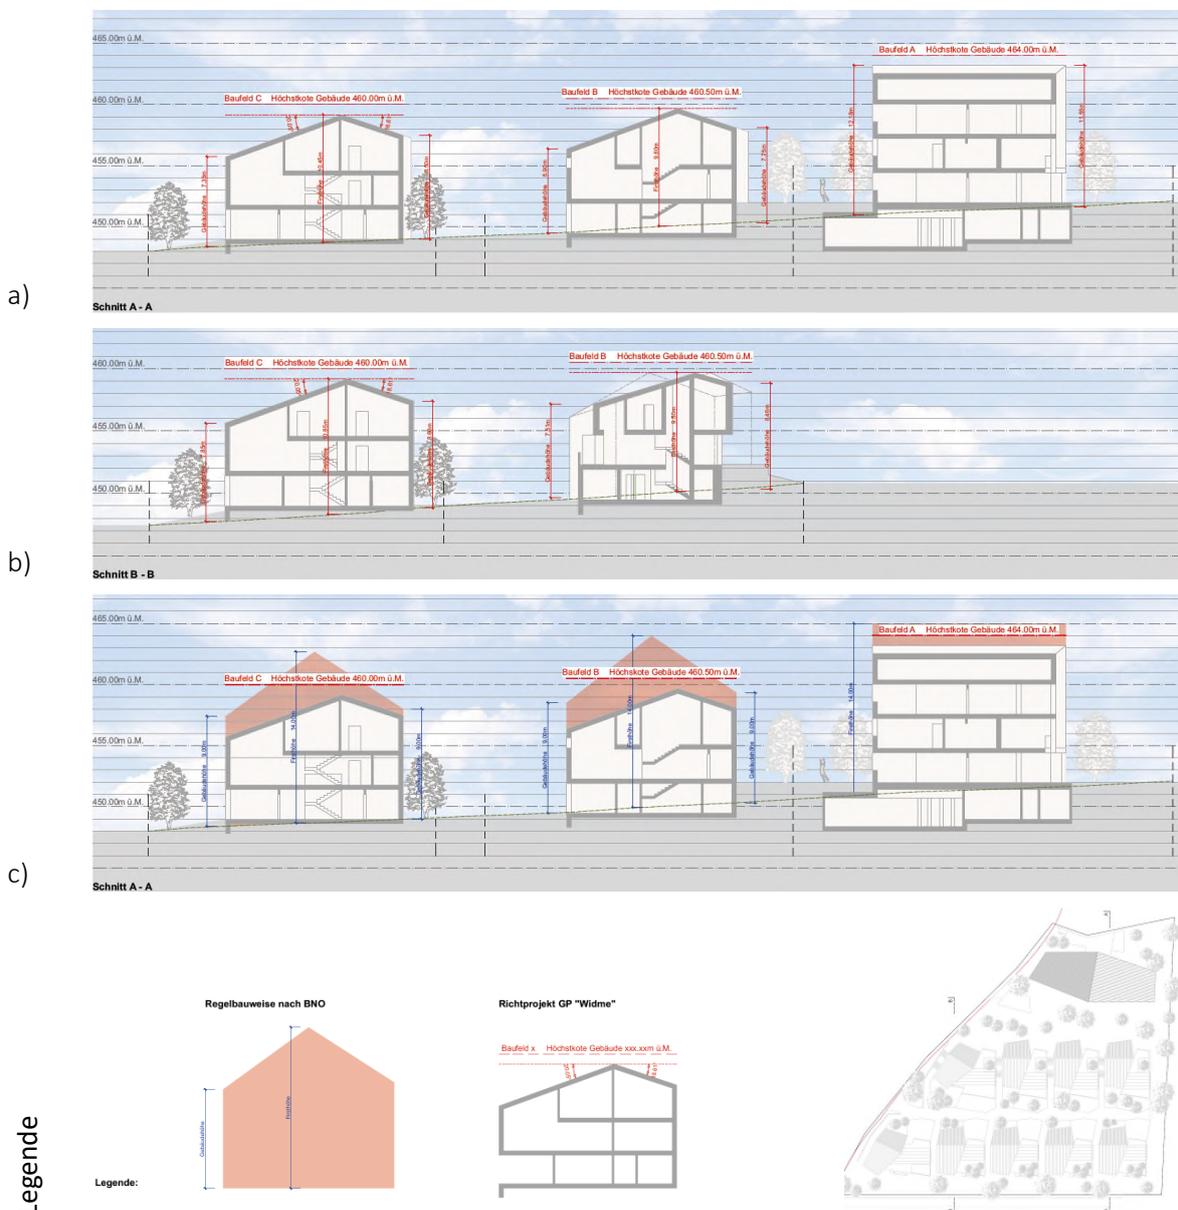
Schnitte Richtprojekt Variante A. a) Schnitt a-a mit Höhenangaben. b) Schnitt b-b mit Höhenangaben. c) Vergleich zulässige Höhenmasse gem. BNO mit Richtprojekt und Vorgabe GP
